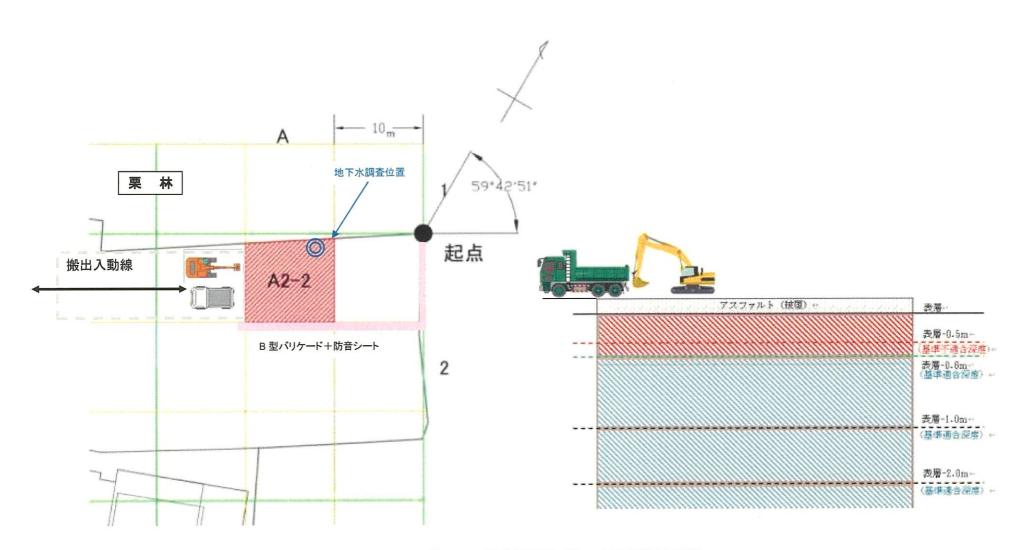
(2) 施工平面図・断面図及び地下水調査位置(実施)
